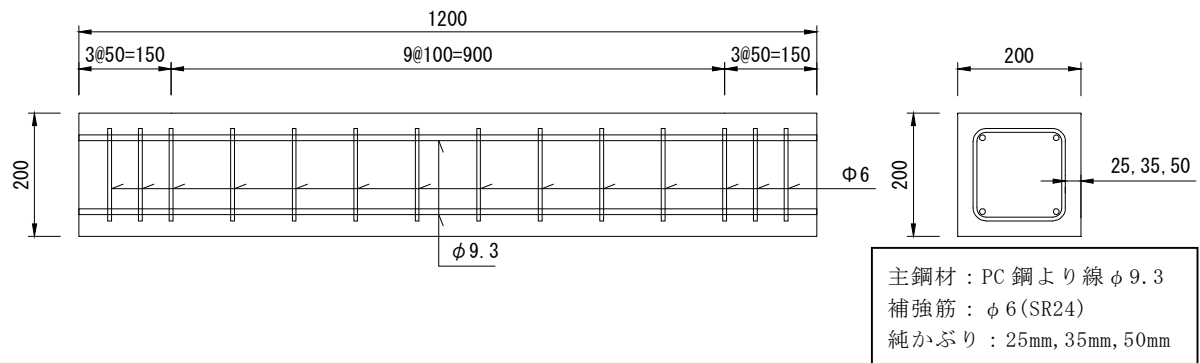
試験体形状（プレテンション方式小型試験体）
